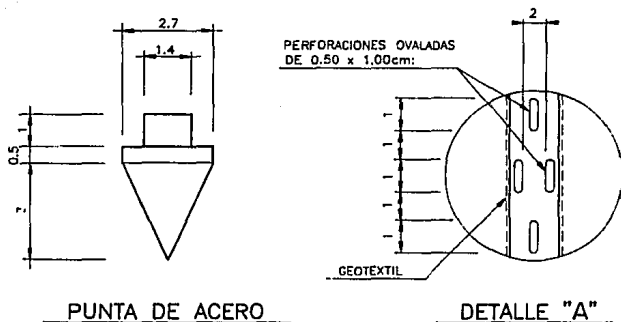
DETALLES DEL PIEZOMETRO ABIERTO
